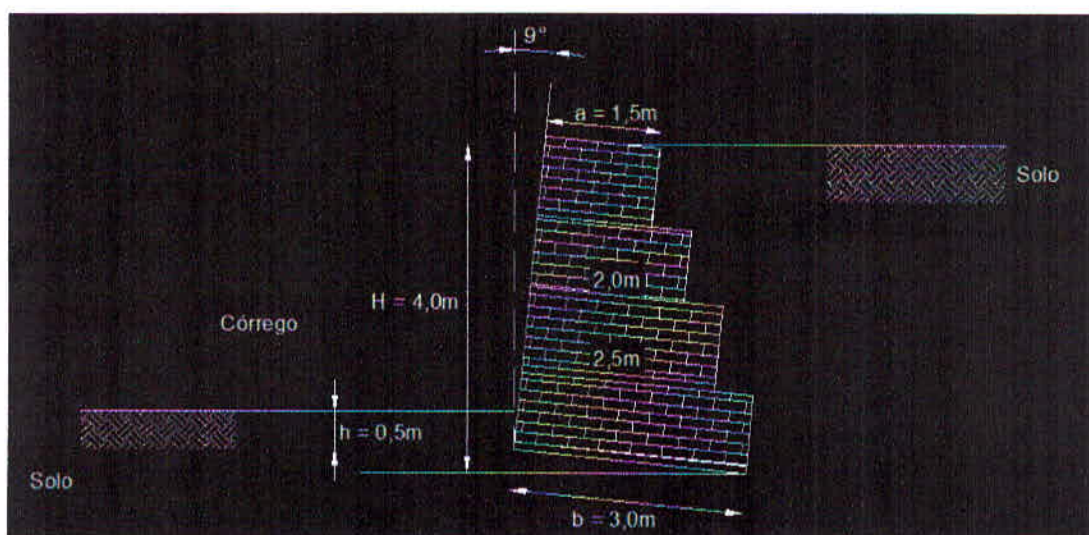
Inclinação mínima para muro em solo cimento ensacado (Fonte: o autor).
